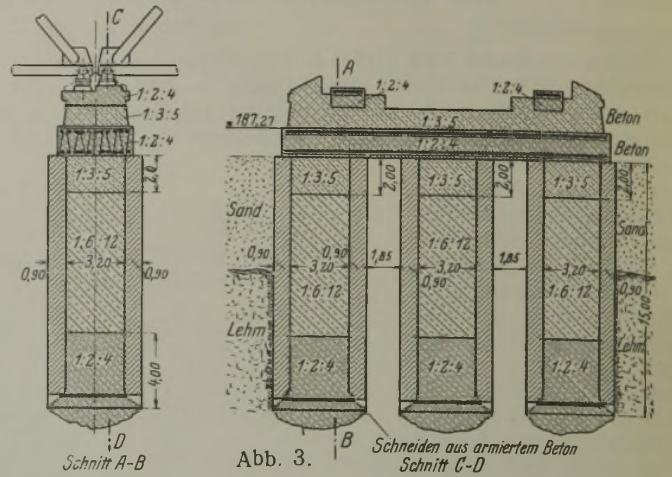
Schnitten aus armiertem Beton Schnitt C-D
